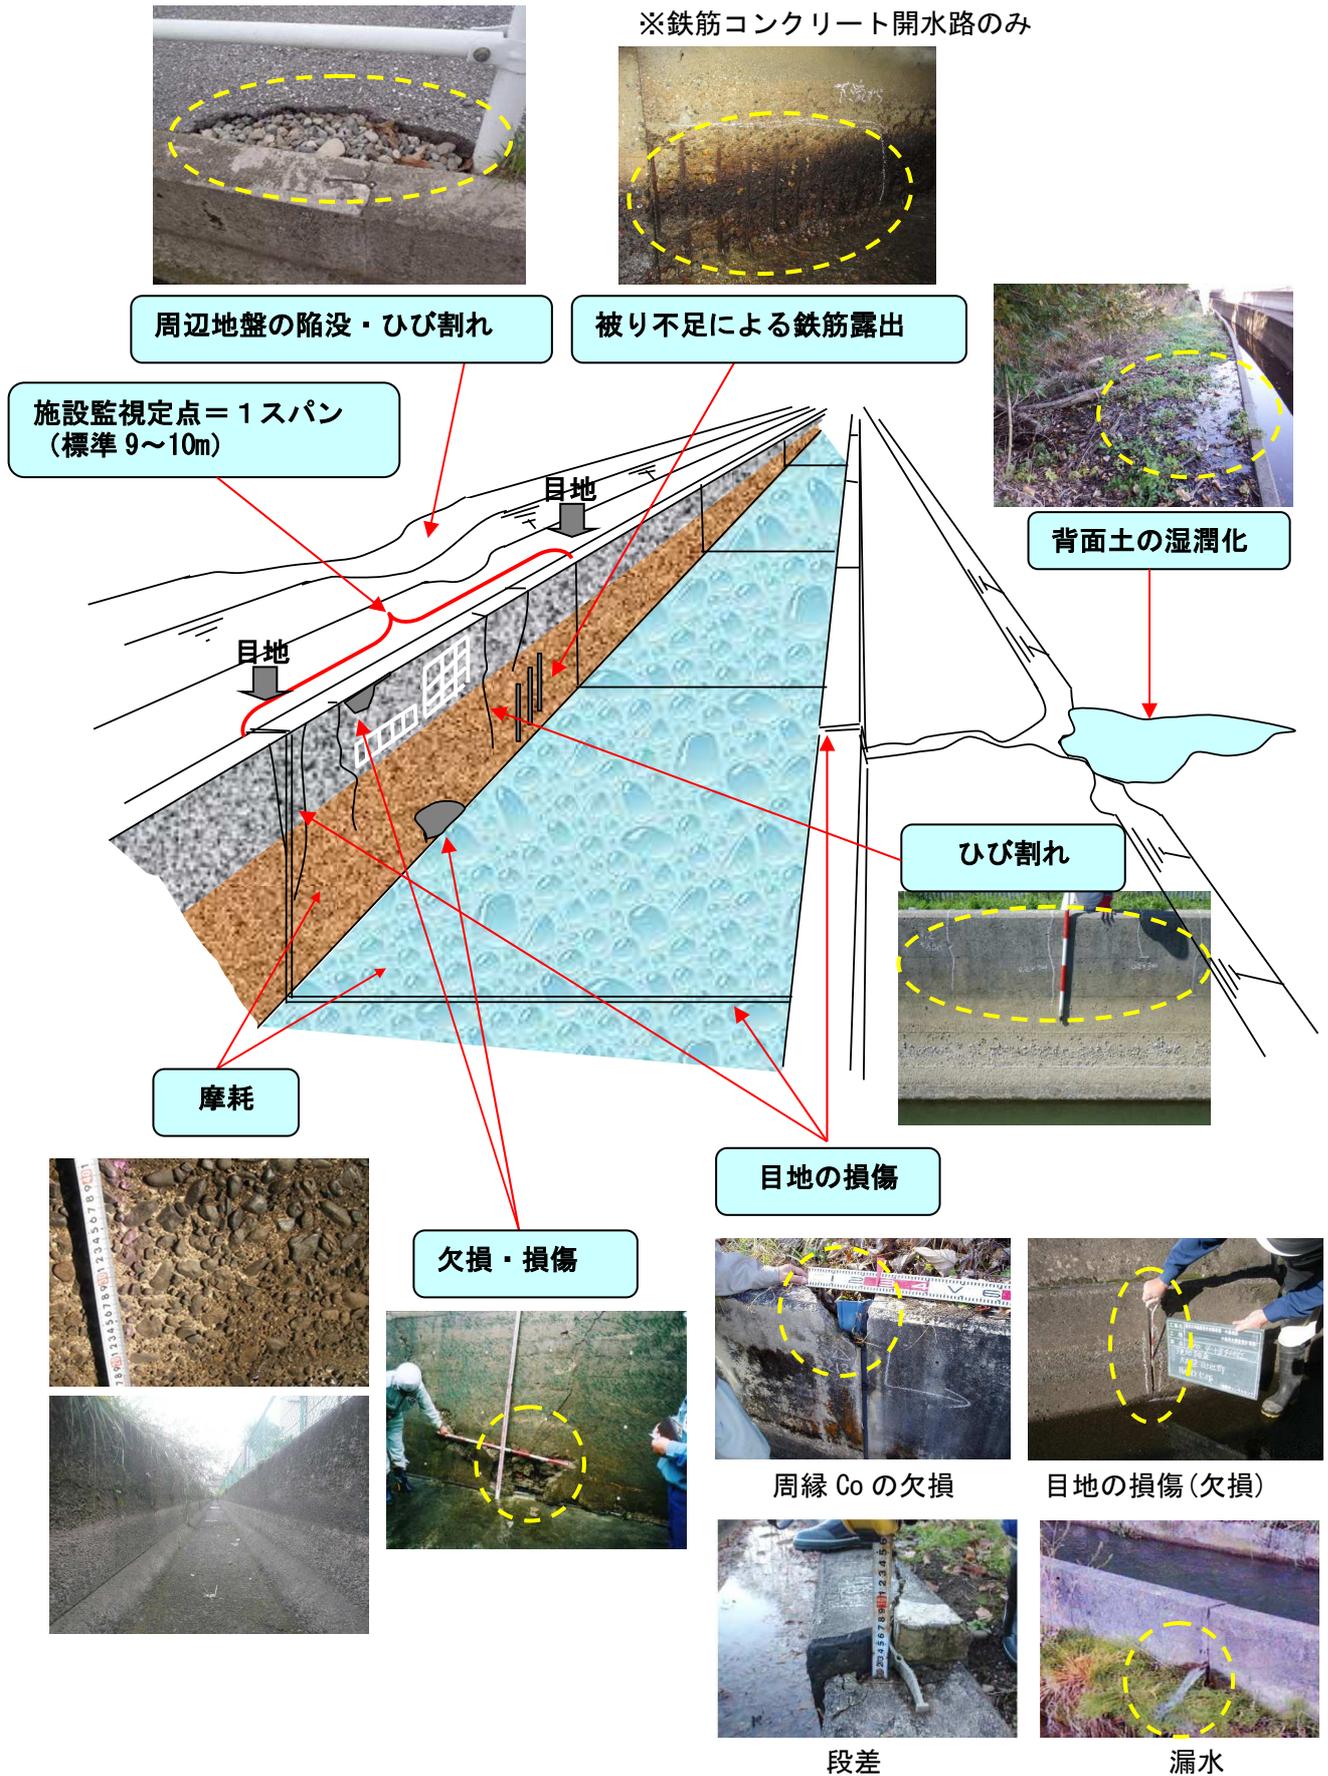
鉄筋コンクリート・無筋コンクリート開水路の主な変状
